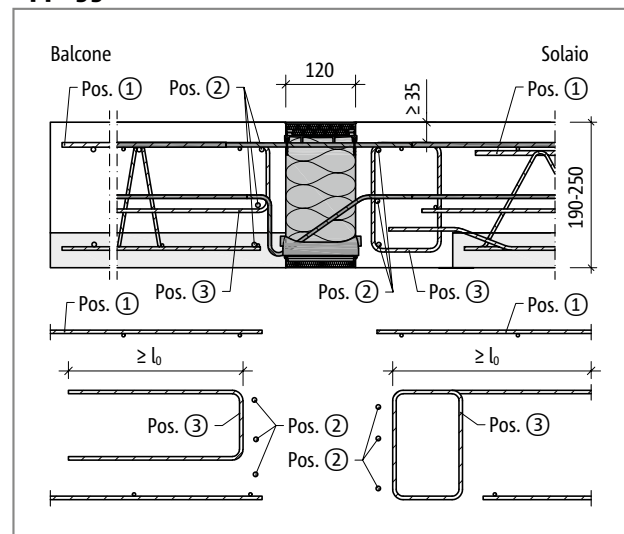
Schöck Isokorb® XT tipo KL-F: armatura in opera con spessore del balcone $h = 190 - 250$ mm
